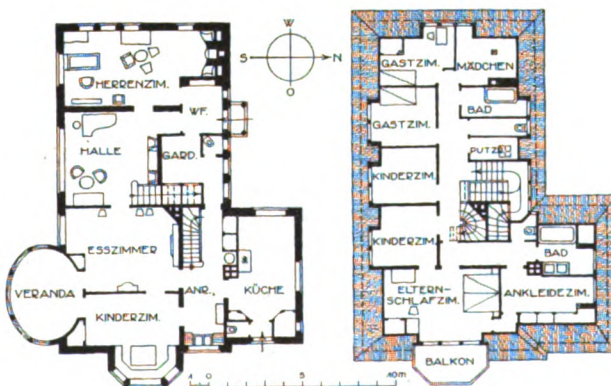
u. 18. Haus Bouncken. — Grundrisse 1:400.
